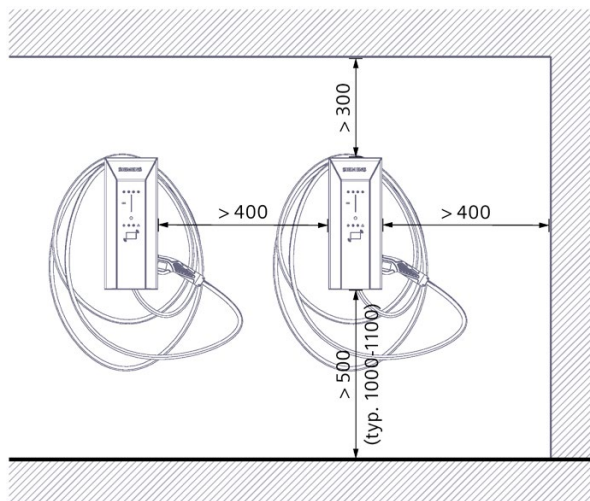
Abstände an der Wand und zwischen benachbarten Wallboxen
